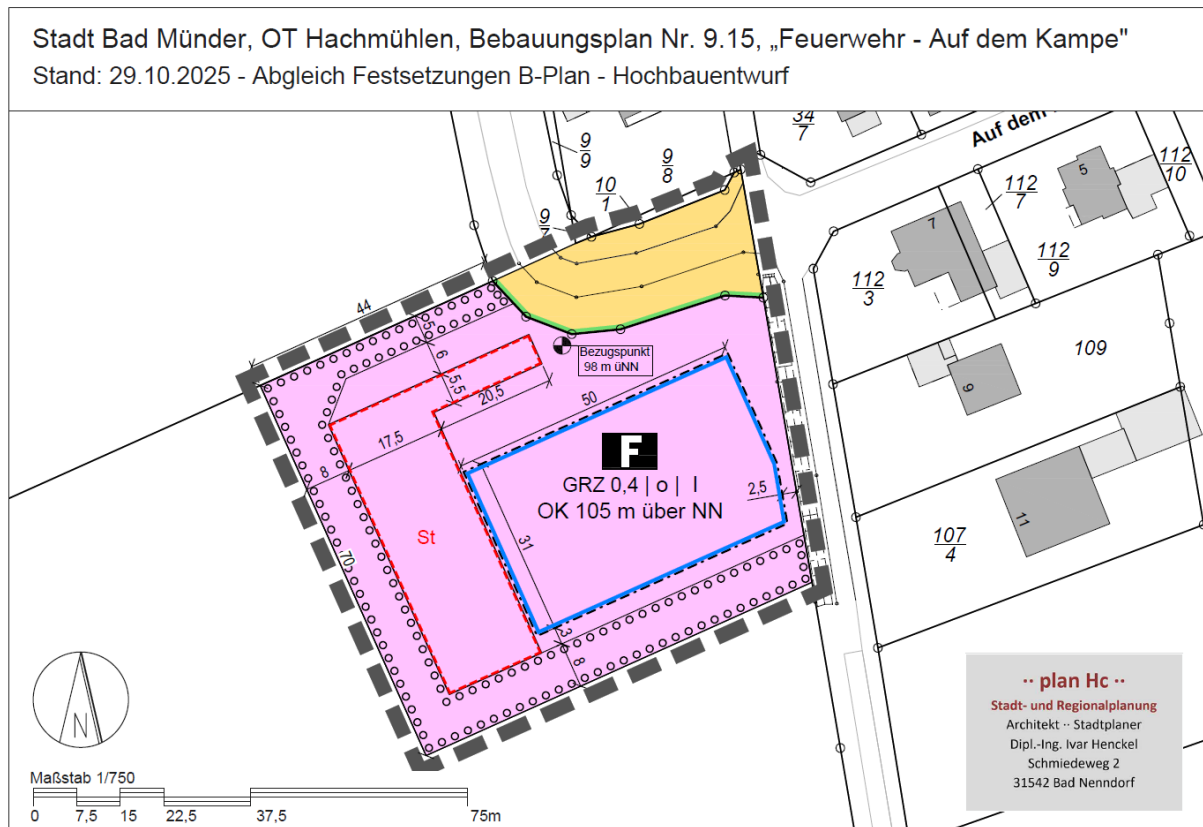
Bebauungsplan Nr. 9.15 „Feuerwehr – Auf dem Kampe“ (Entwurf: plan Hc - Stadt- und Regionalplanung, Stand: Oktober 2025)
